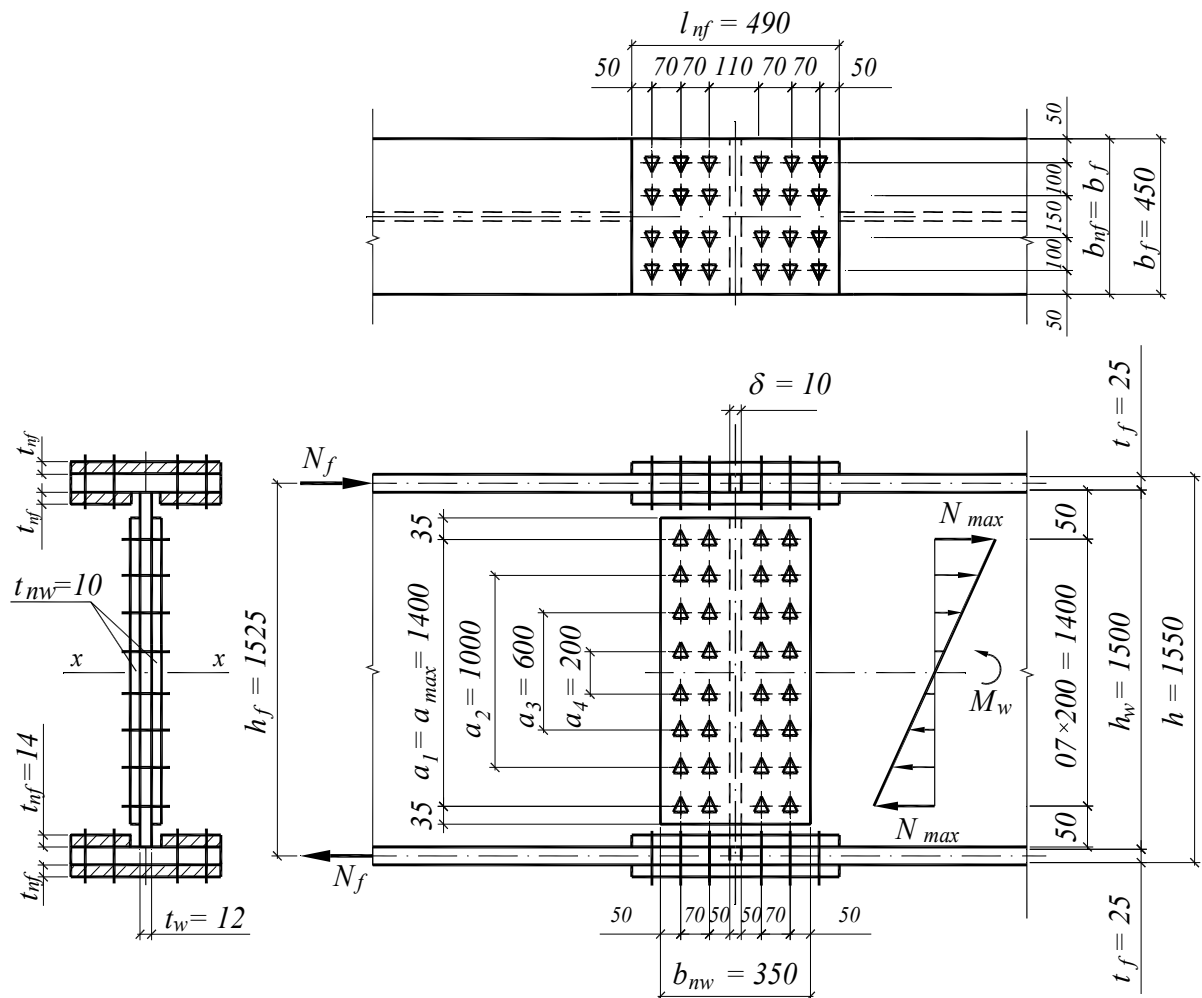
Монтажный стык сварной балки на высокопрочных болтах
